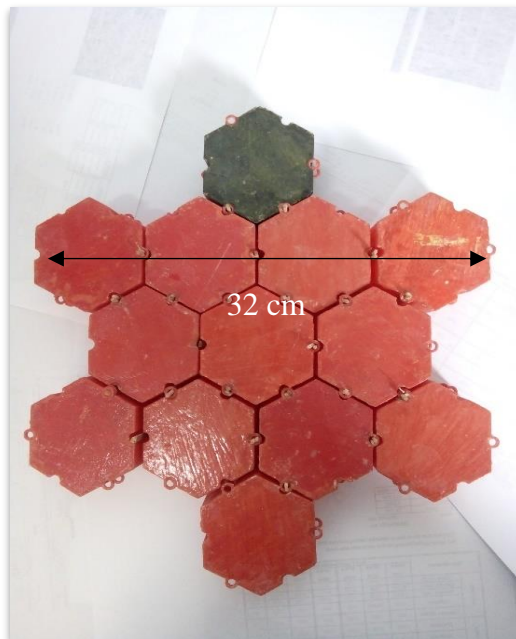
8 Bentuk *concrete block anchor* dan sensor Load Cell
